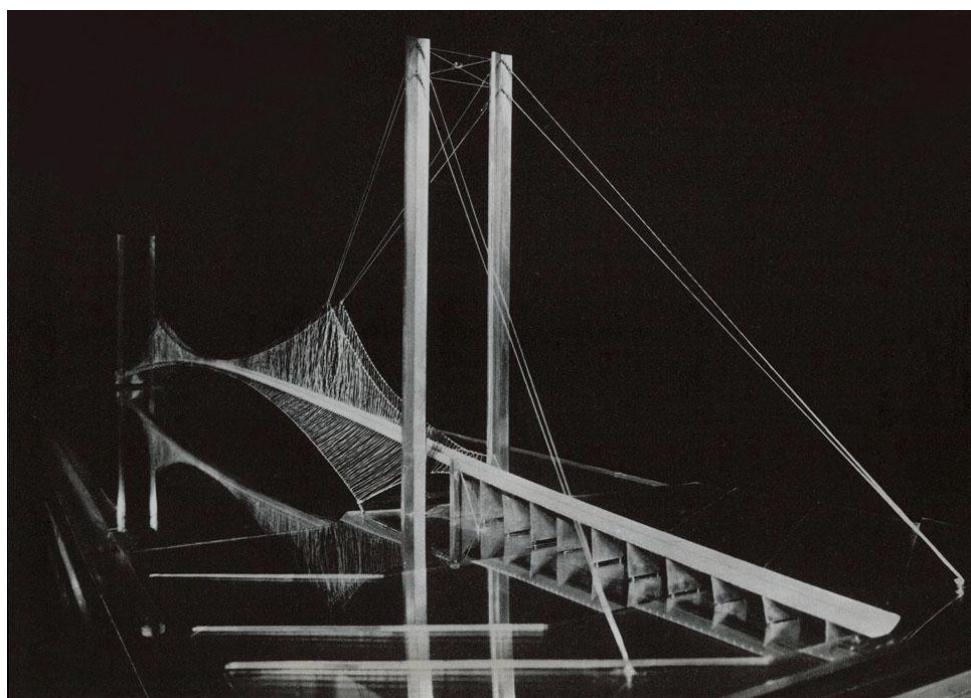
progetto ponte sullo Stretto di Messina (1970)
